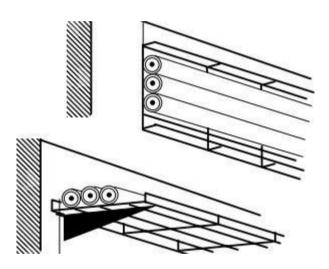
Bandeja pasacables (colocada en suspensión entre las dos fachadas)
